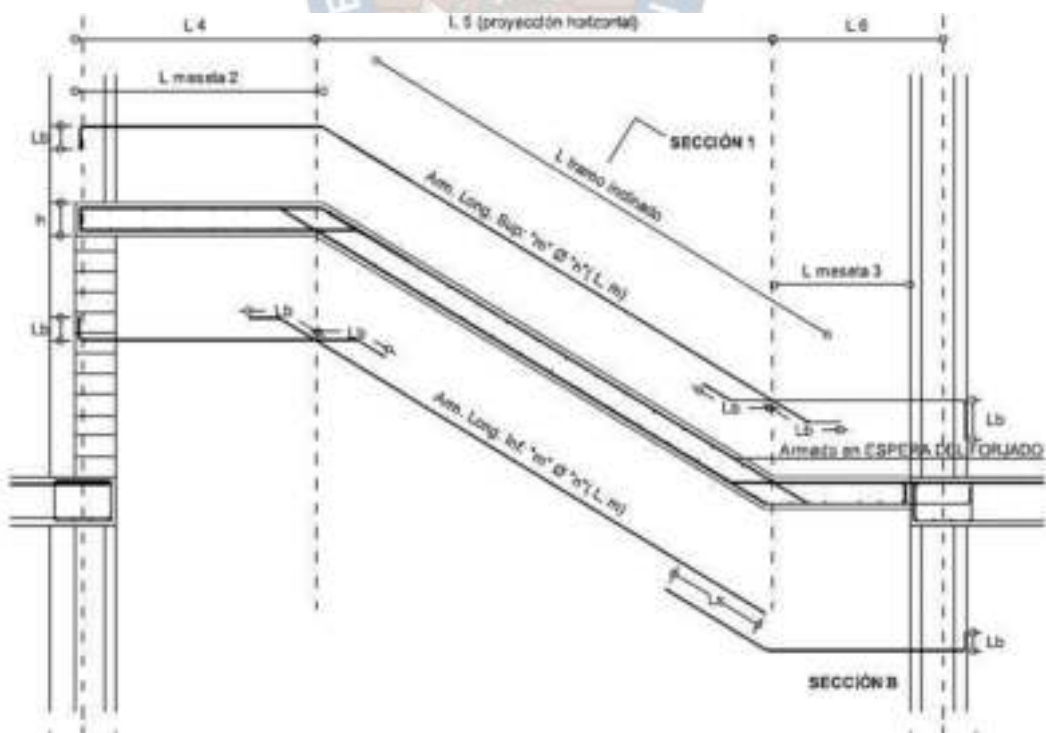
Detalle de la armadura de una escalera típica tramo II
